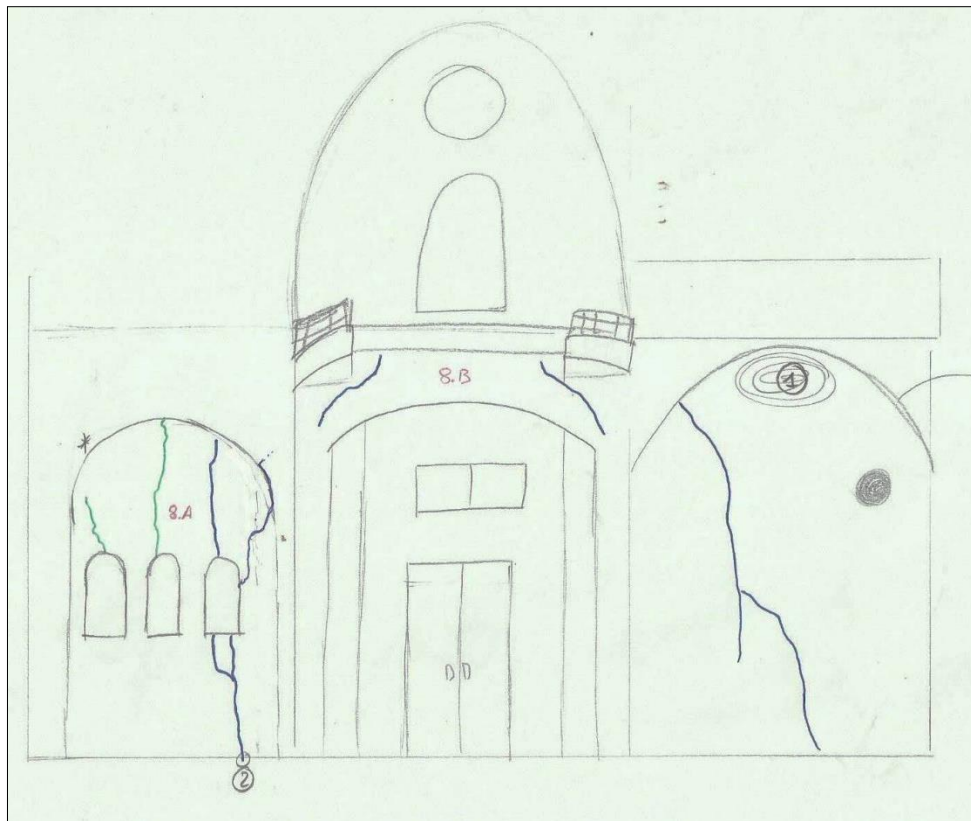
Plano grietas cara sur interior (sección G-G')
